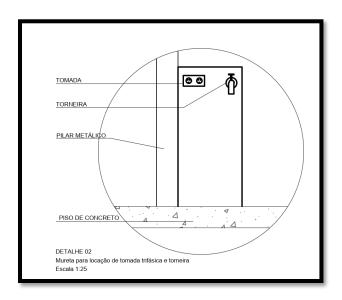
Detalhe da Mureta em alvenaria, conforme o projeto
